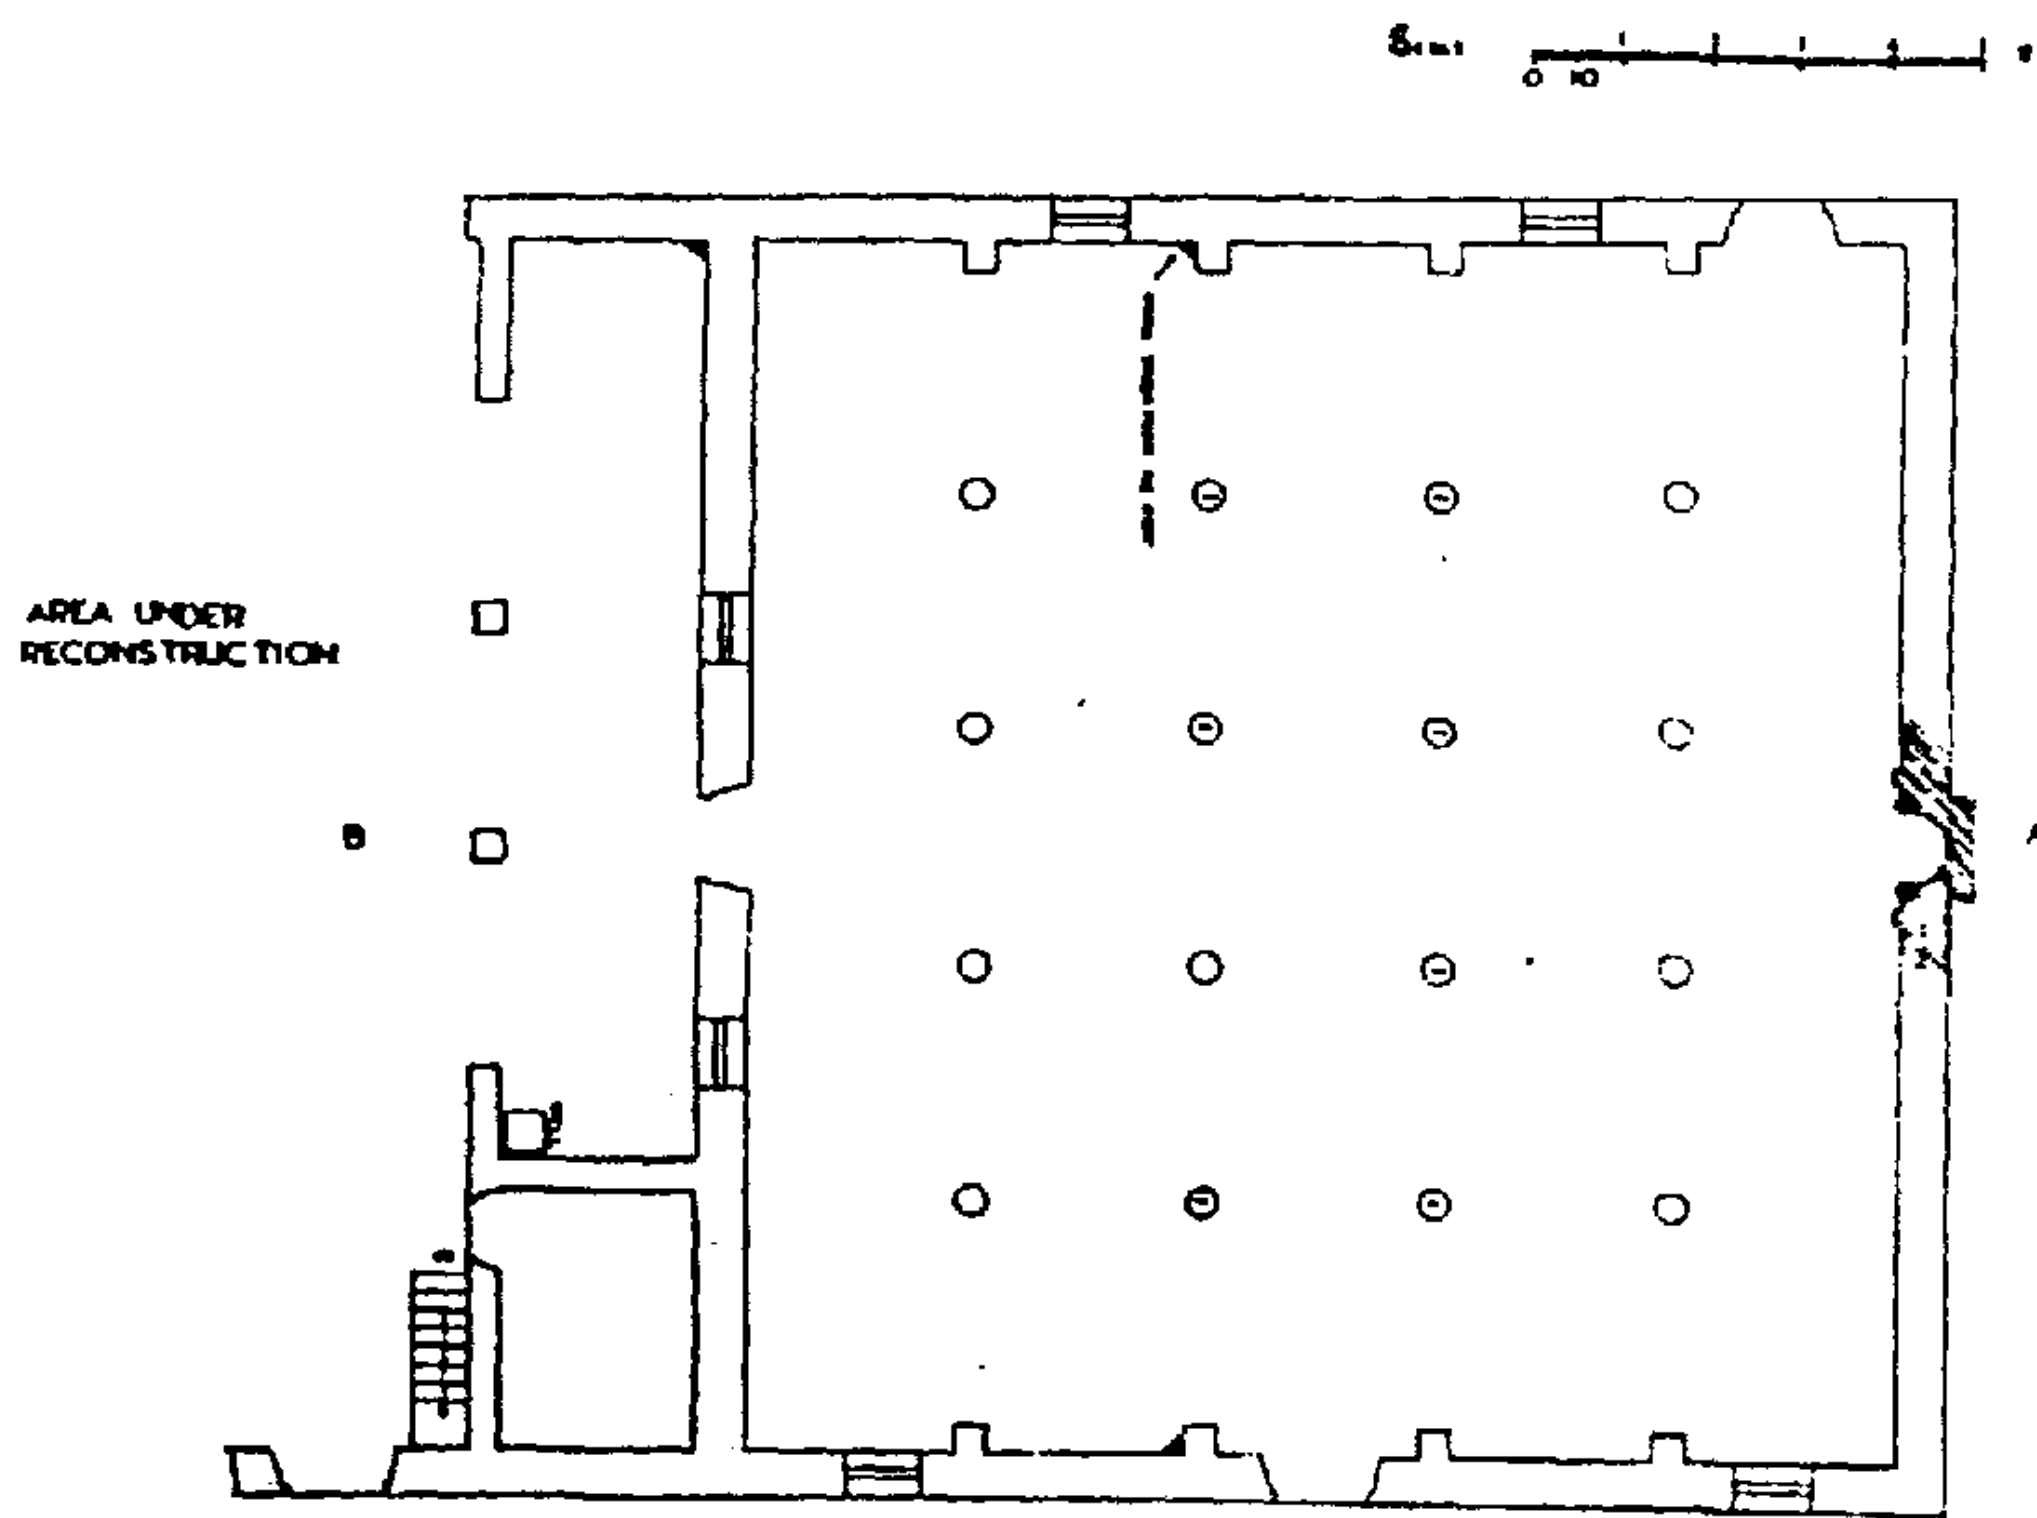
مسقط أفقي لمسجد المدينة. (عمل الباحث)
